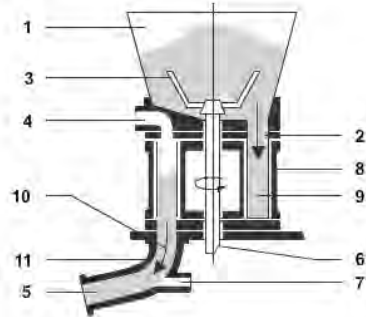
machine de projection type rotor. Site www.lmtgroup.fr
